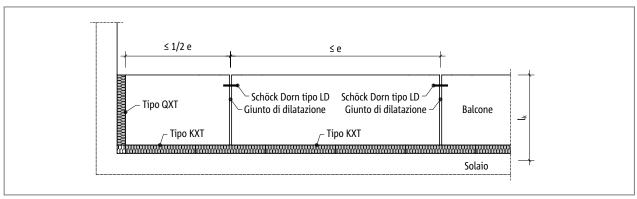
Schöck Isokorb® tipo KXT: disposizione dei giunti di dilatazione
